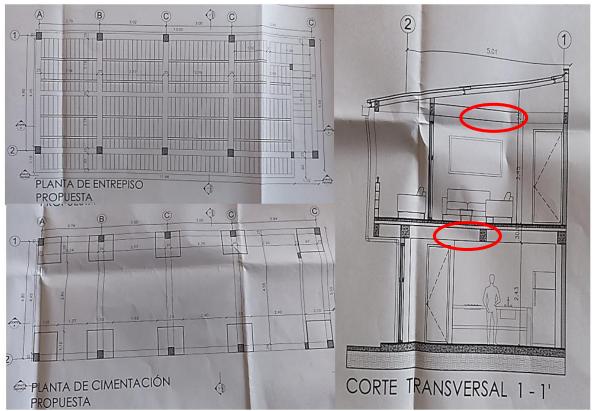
[Fotografía Andrés Vargas] Detalle de la ubicación de las vigas de confinamiento (cimentación, entrepiso, cubierta)
